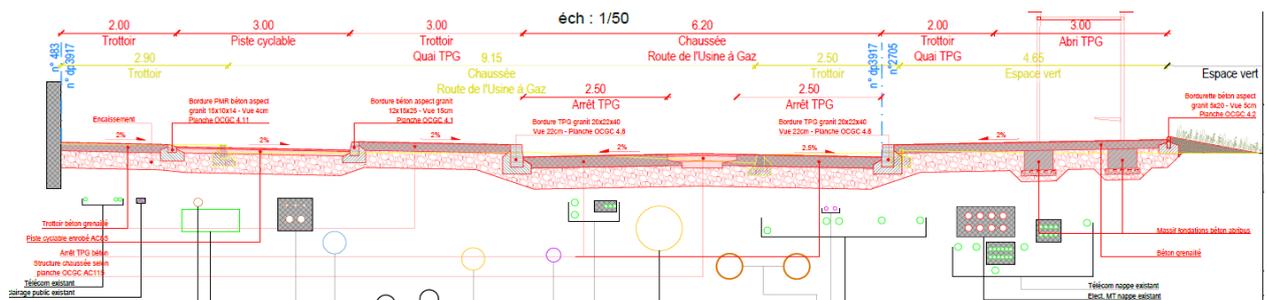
Coupe au droit de l'arrêt TPG « Usine-à-Gaz »
